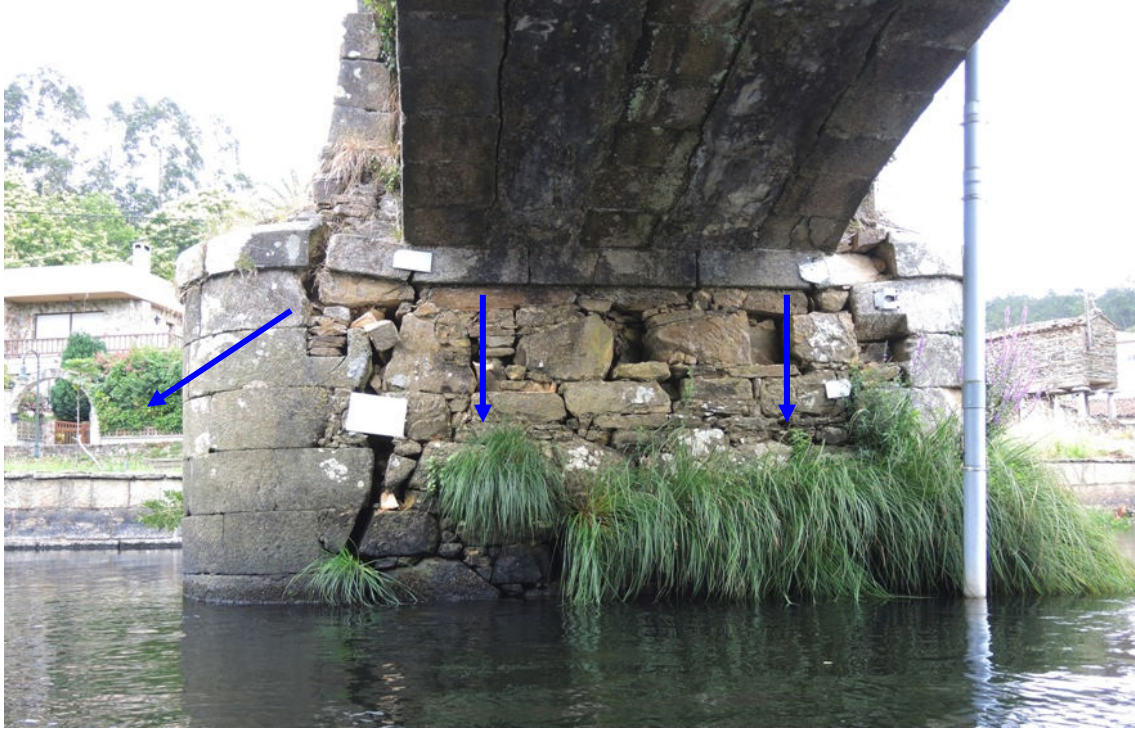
Asentamiento del cuerpo de mampostería de la pila
